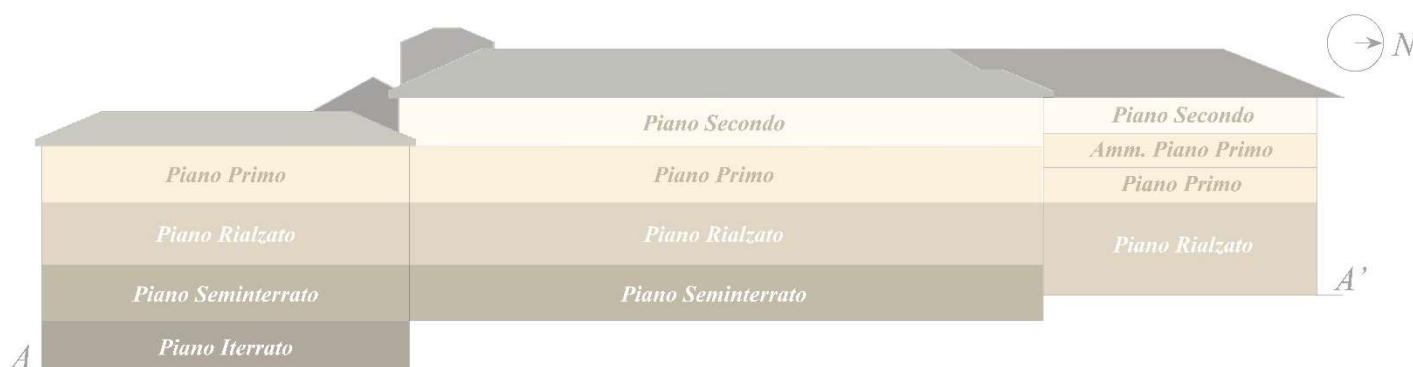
Sezione schematica (Fonte: Elaborato dell'autore)
